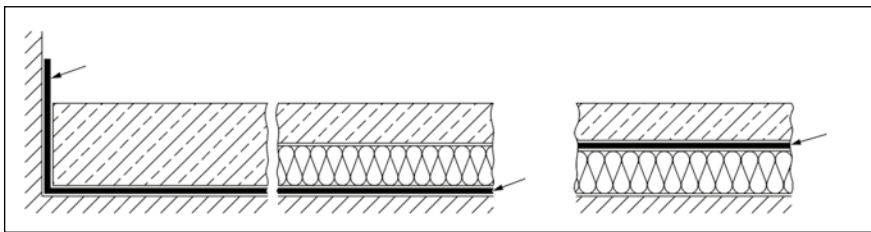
■ Bauweise mit Abdichtungsschicht unterhalb eines Estrichs (DIN 18534 [1])
